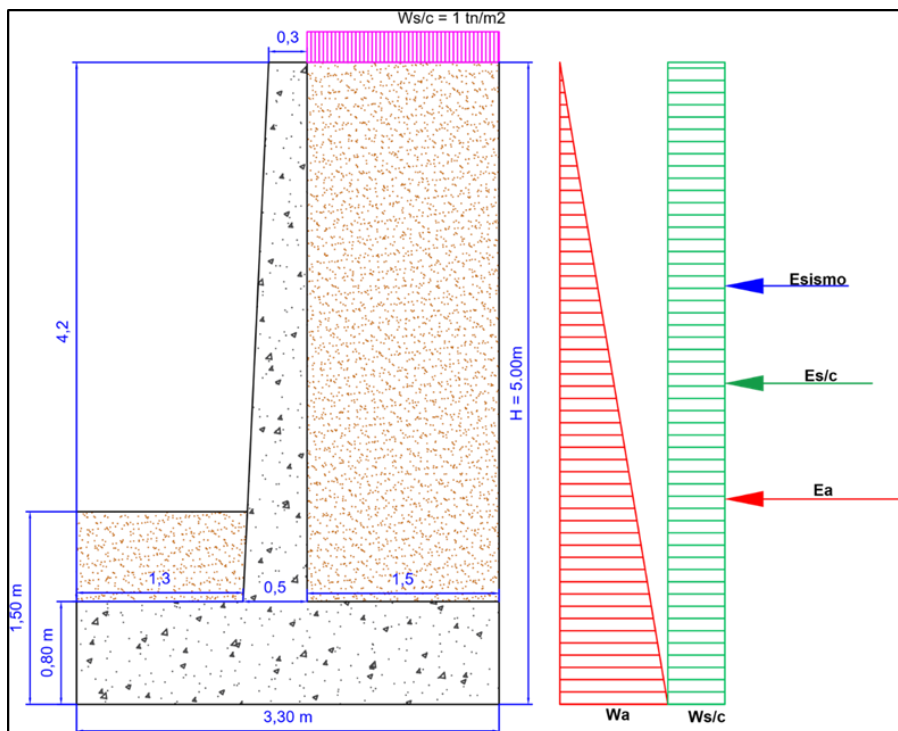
fuerzas actuantes sobre el muro en voladizo.
